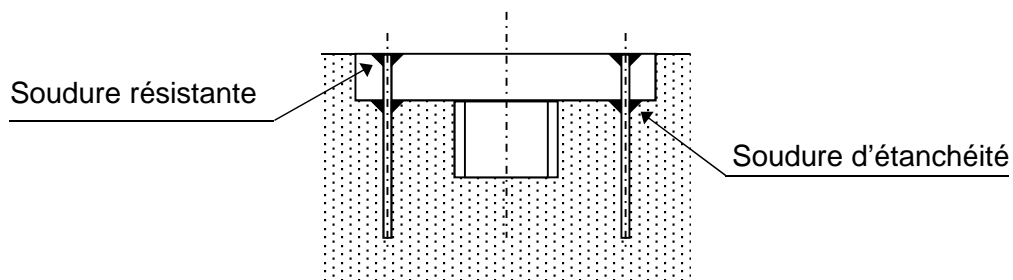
Plaque d'assise équipée de tiges d'ancrage.
